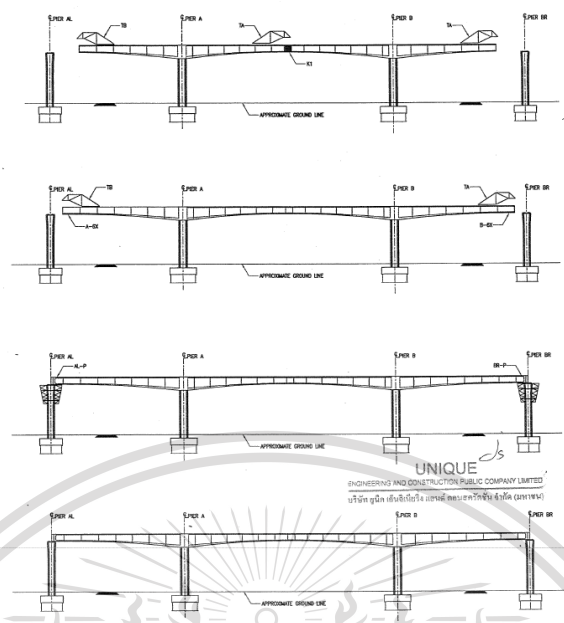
Construction Stage ส่วนแรก
